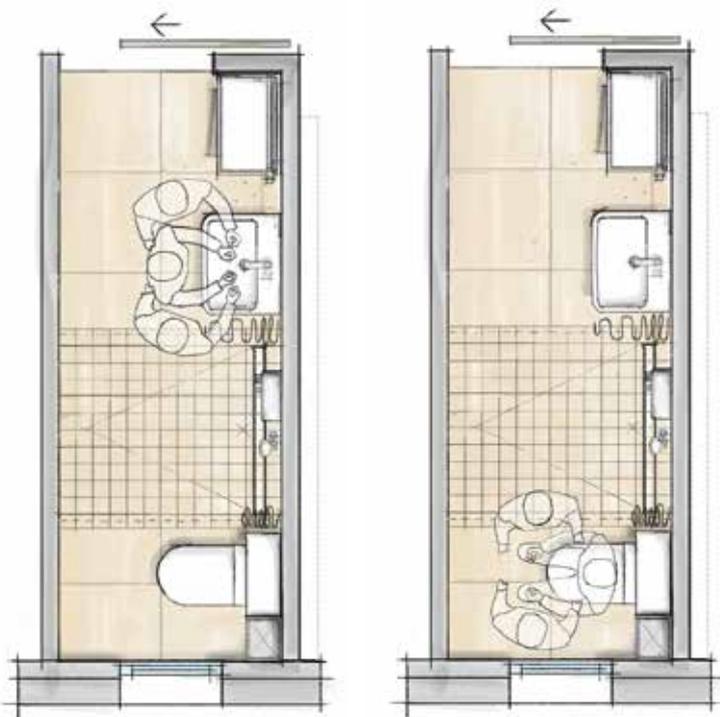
Umbauvariante 4 – Schlauchbad mit Assistenz an Waschtisch und Toilette (Grundriss: DLW)
